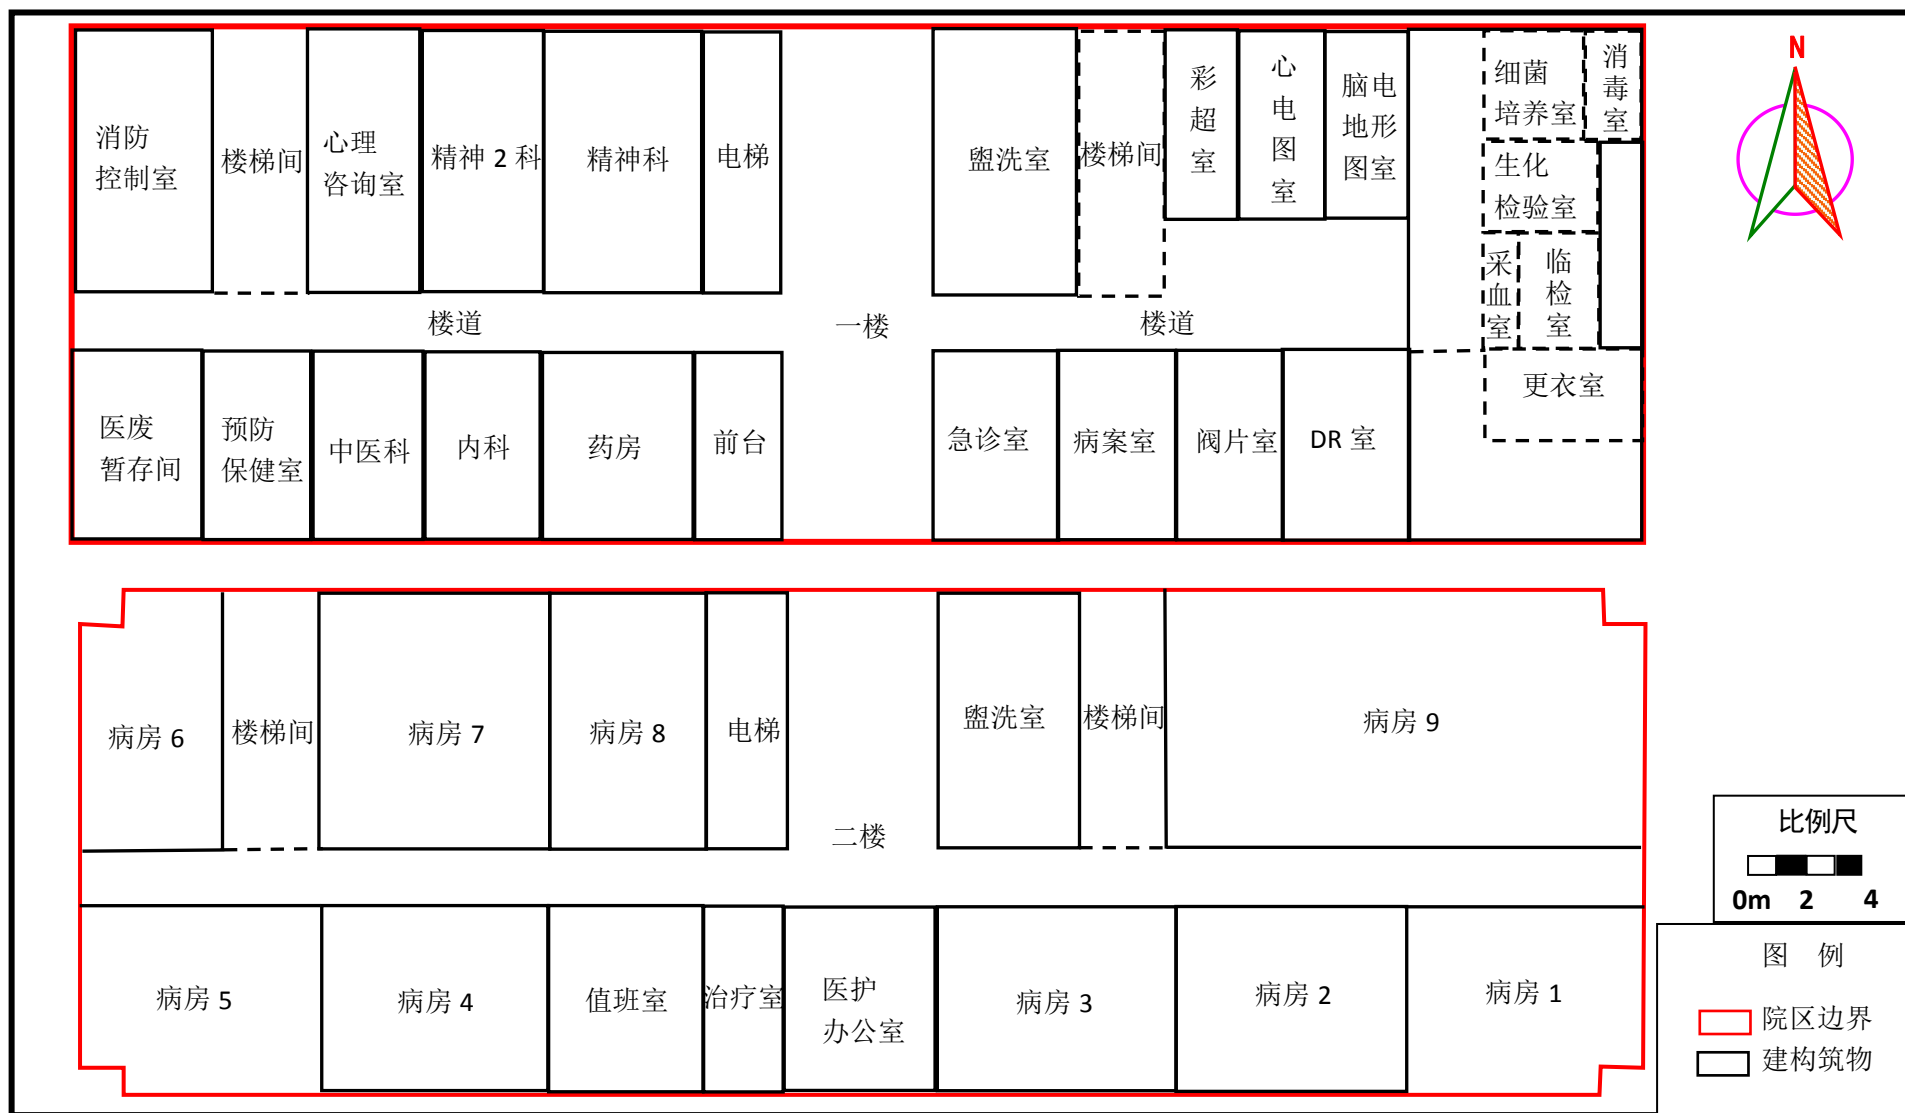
项目门诊综合楼一楼、二楼平面布置图
